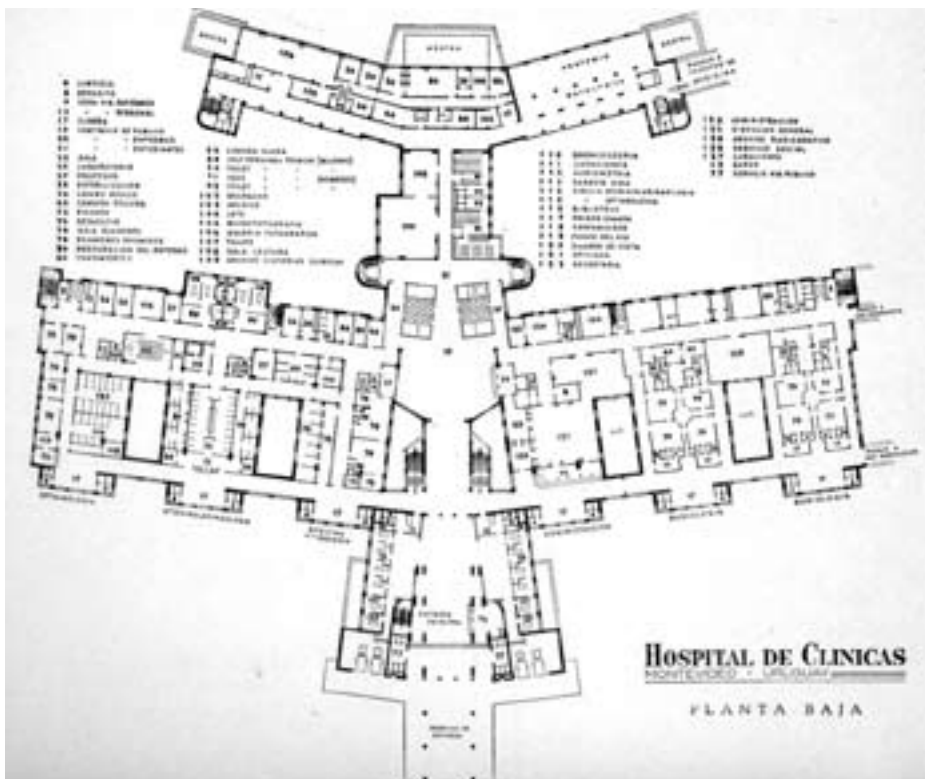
Corte horizontal de la planta baja. (FDAN).
